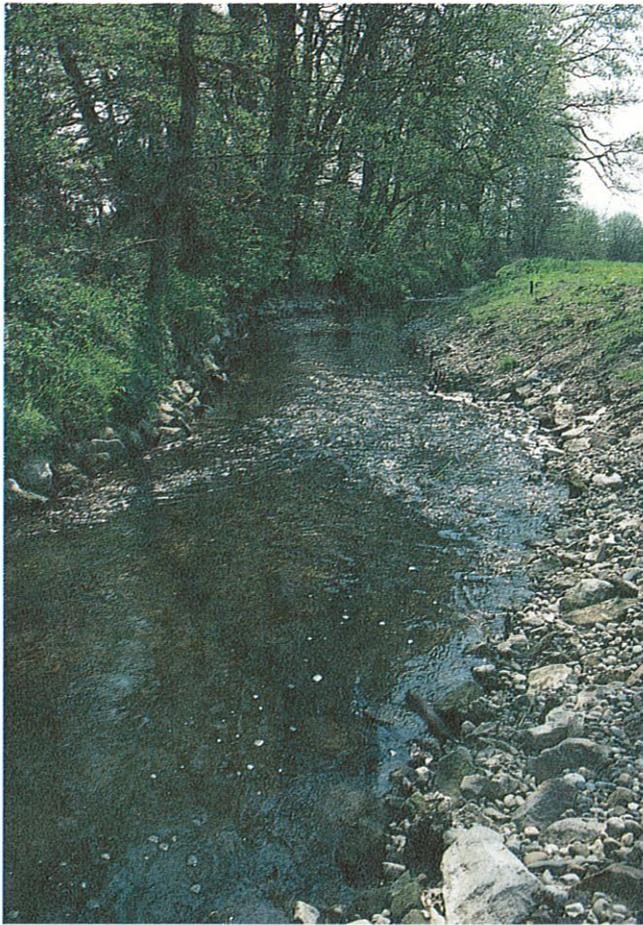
Ausbaustrecke im Mai 1988 (Ausbau 1987)
